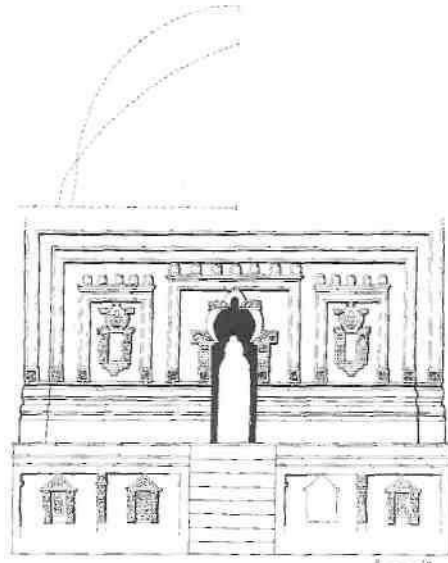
Croquis d'une façade du mausolée du Sheikh Sadān.
